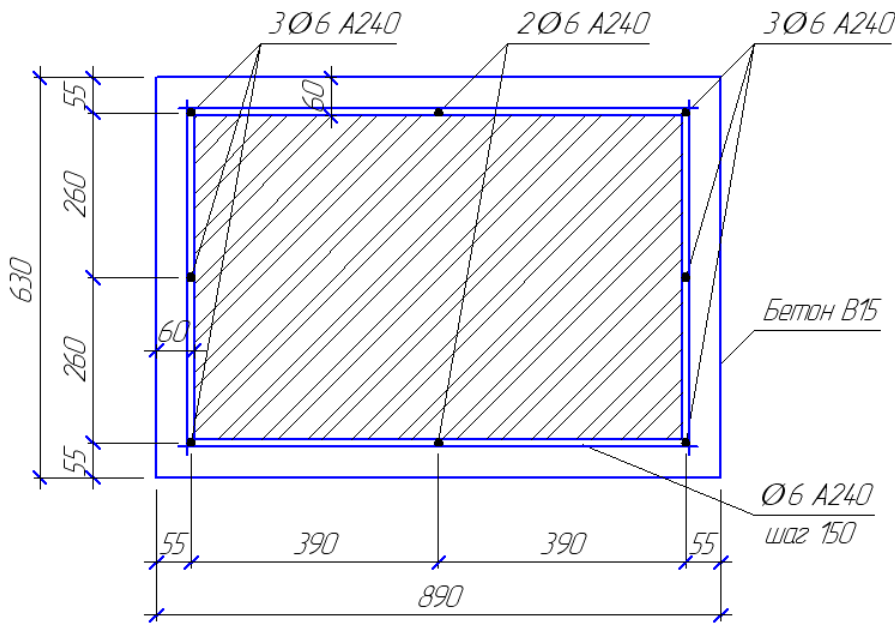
Схема усиление кирпичного столба железобетонной облоймой
